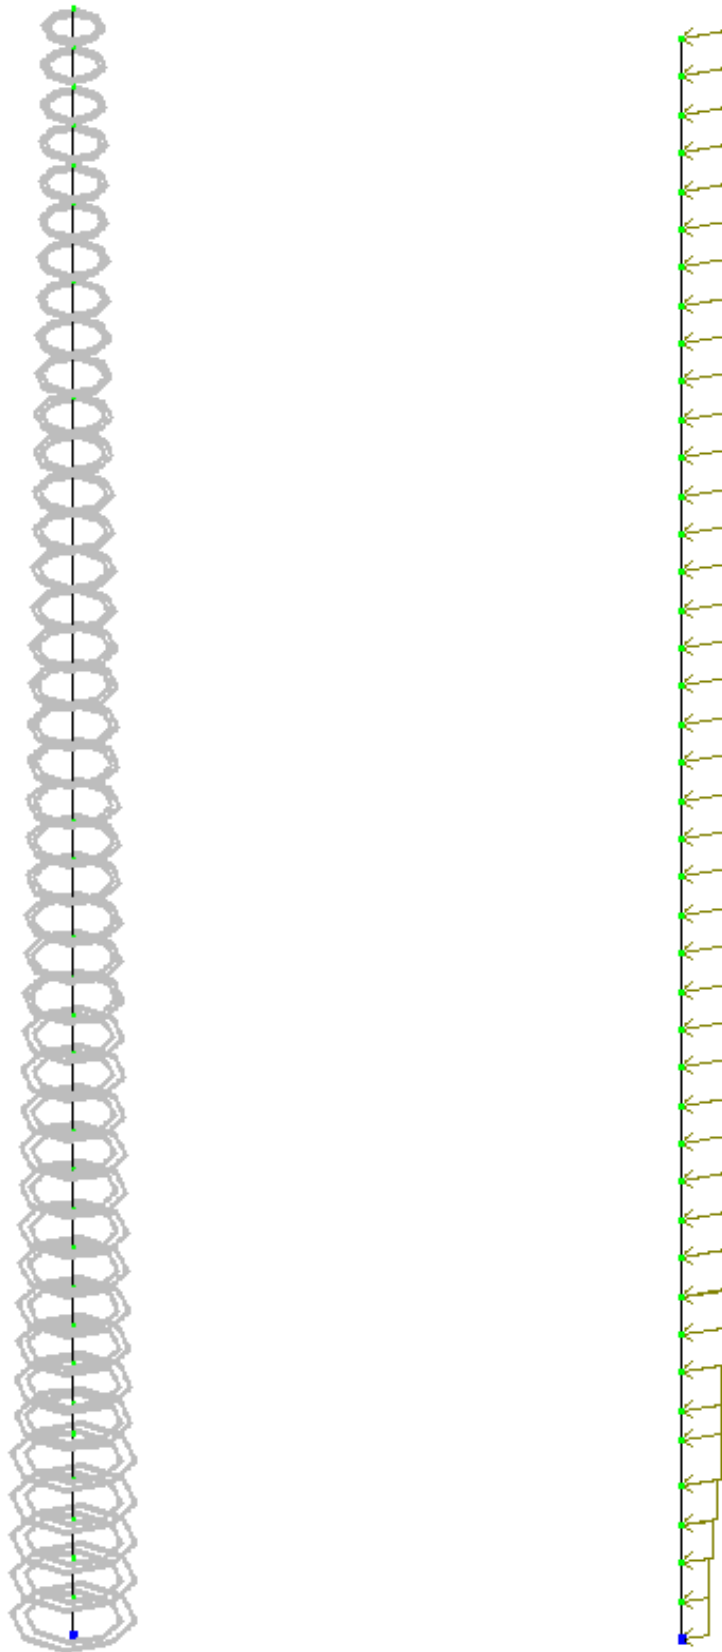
Схема нагрузок на дымовую трубу.
